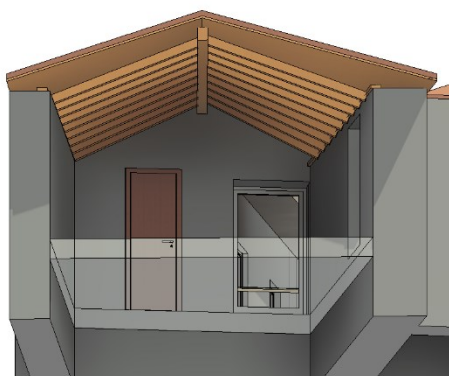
Modelado de cubierta propuesta. Fuente: elaboración propia sobre captura de Revit.
